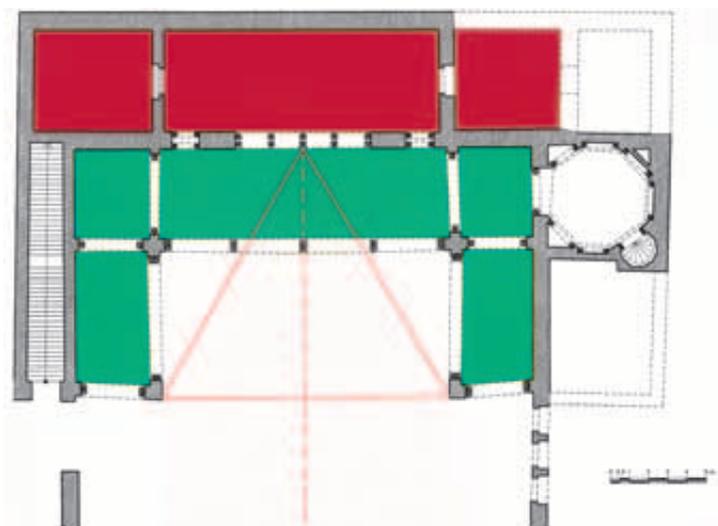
Zaragoza. Plano de la planta del testero norte del palacio islámico de la Aljafería, según Christian Ewert, en el que los autores de este artículo han indicado en color rojo el Salón Dorado y sus dos alhanías extremas que contaban con dos plantas y en color verde el deambulatorio o ambulacro de tres brazos que le precedía.
